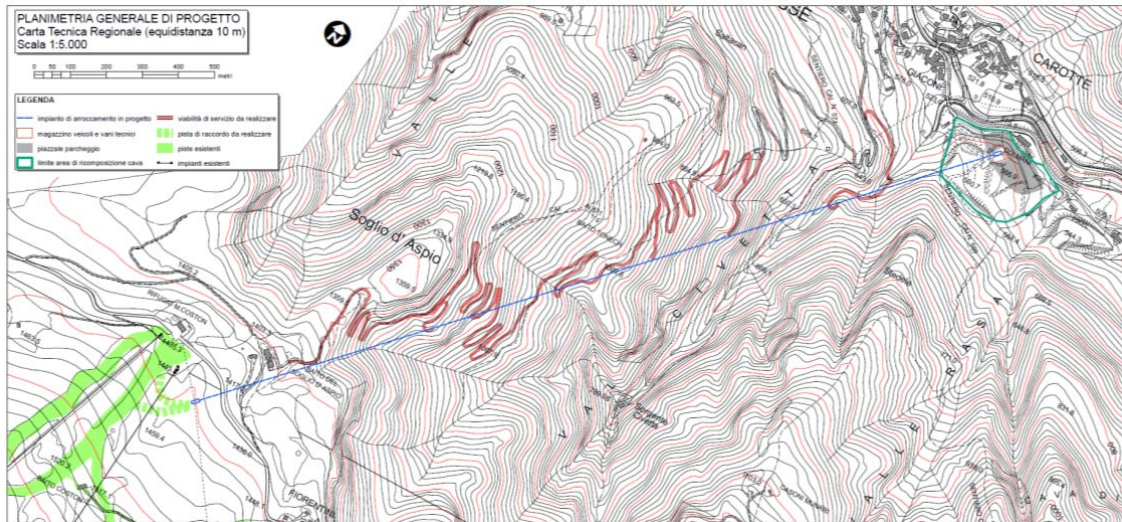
Planimetria generale fonte Progetto Preliminare 2012 Comune di Lastebasse
